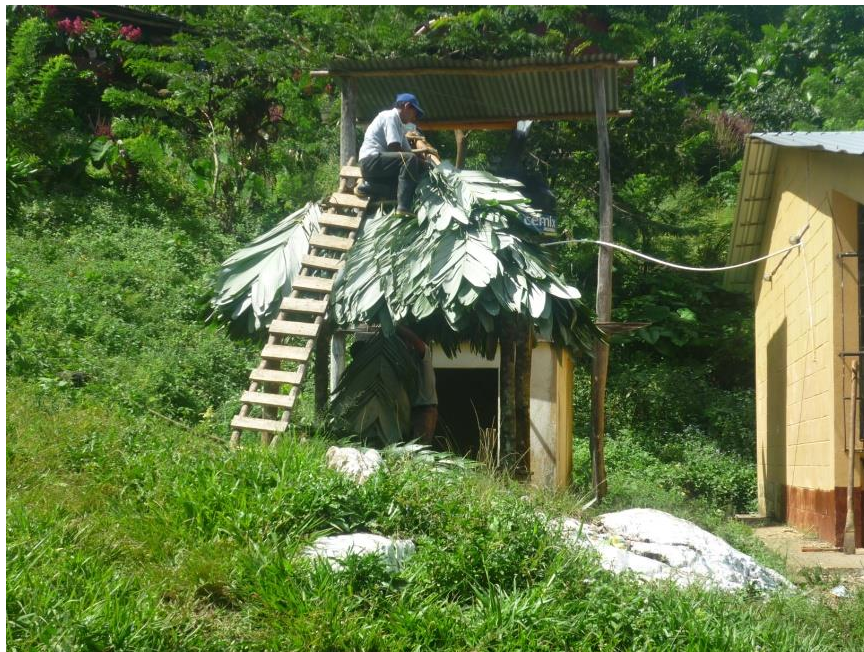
la selección del terreno para la construcción de rancho ecológico
